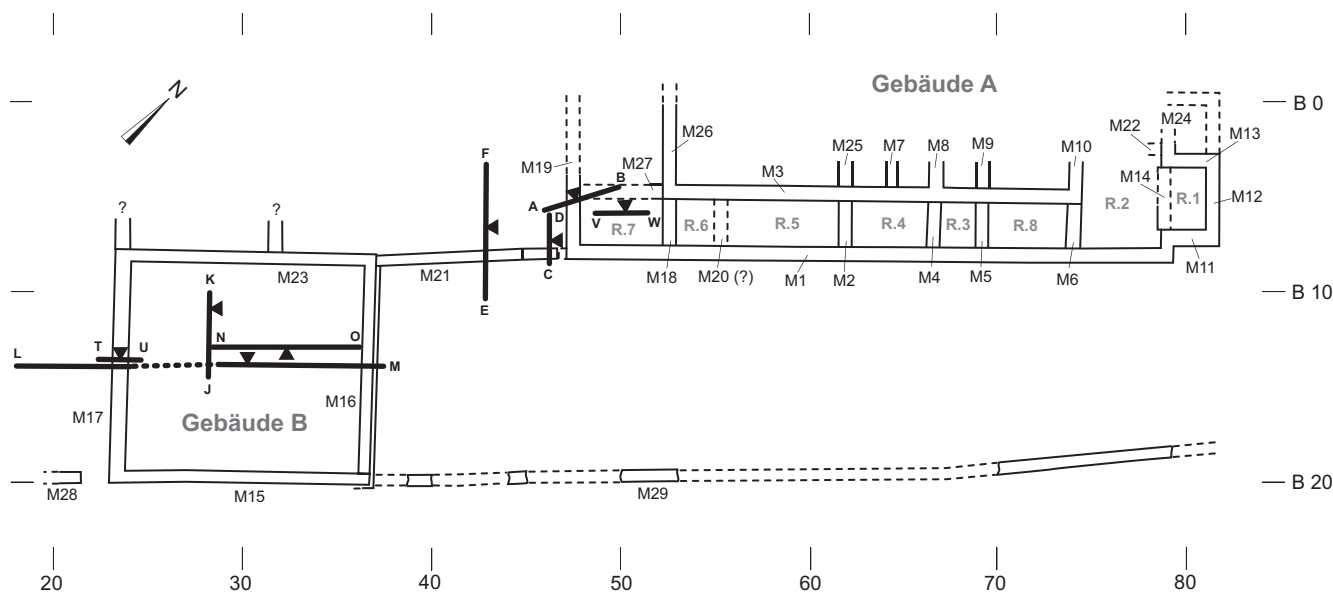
Zürich-Strickhof/Mur. Schemaplan Gebäude A und B mit der Lage der Profile. M. 1:400.
